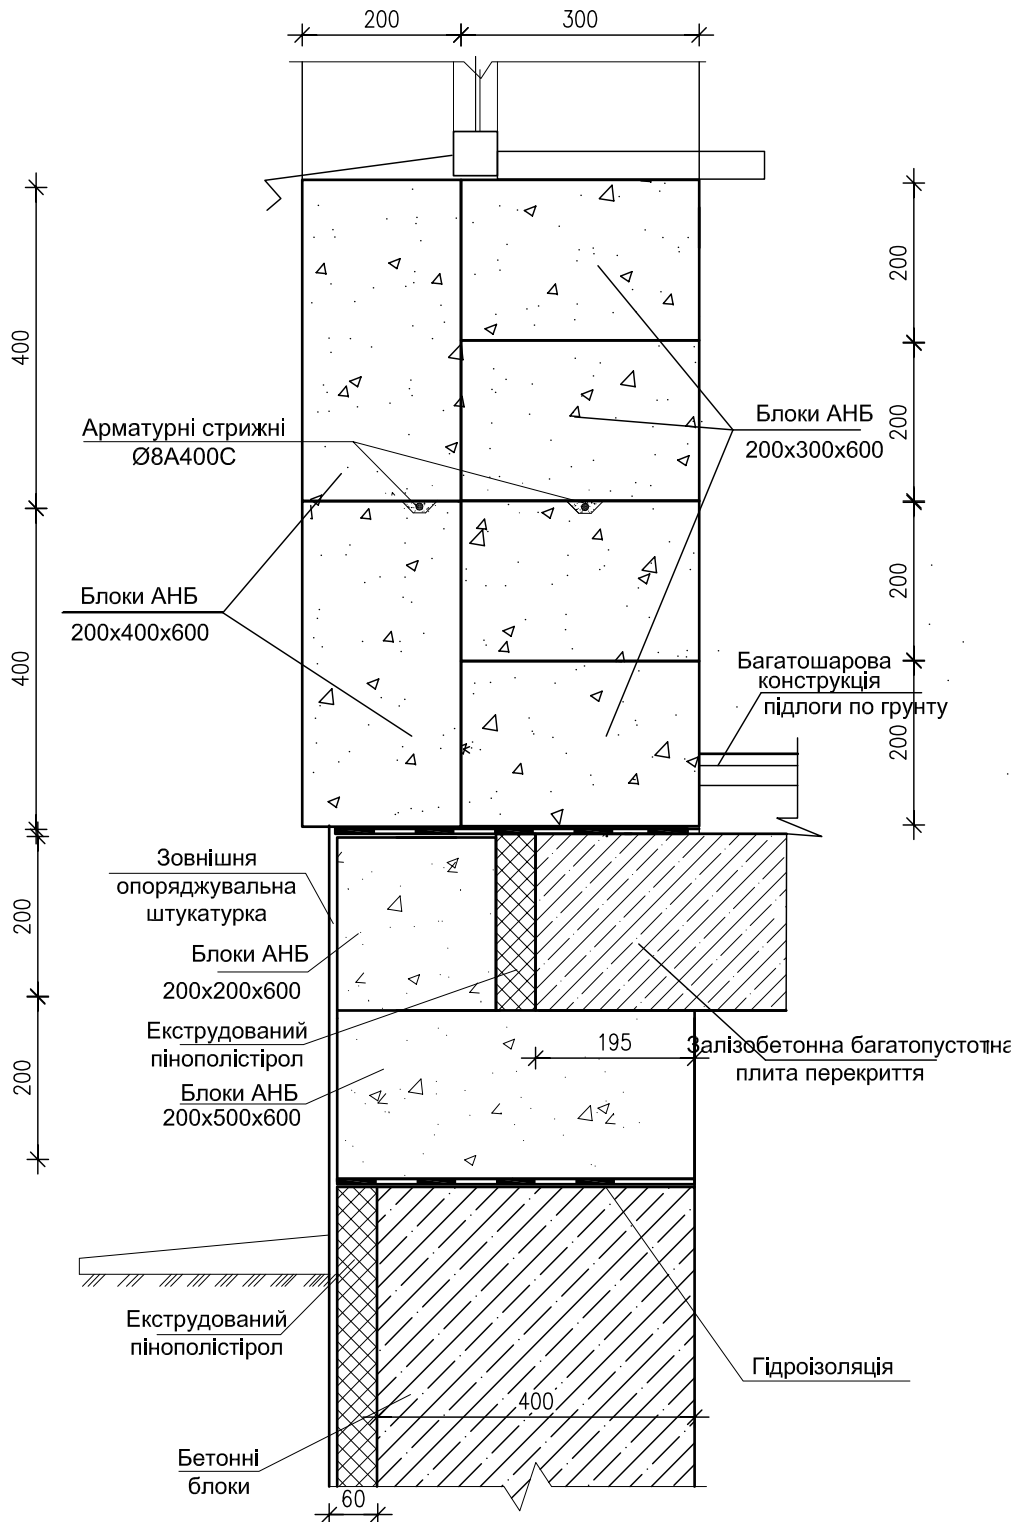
Двошарова стіна другого типу. Вузол спирання стіни на блок фундаменту.
